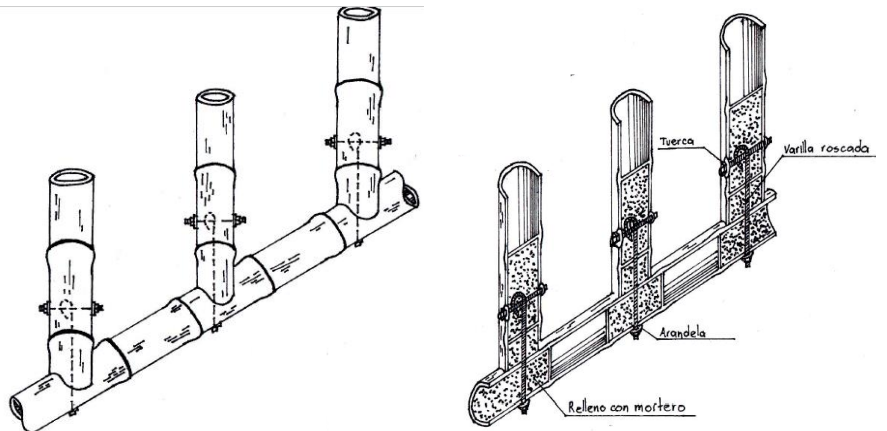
Detalle propuesto para la protección del elemento. Fuente: Elaboración propia.
